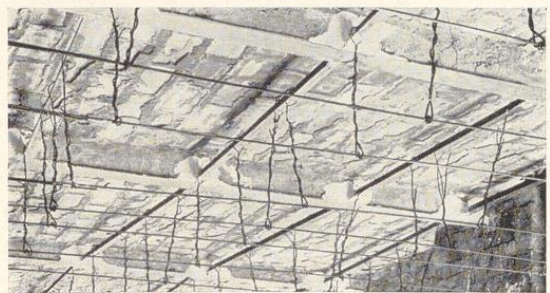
Gute Abhängung an einer eisernen Trägerdecke
